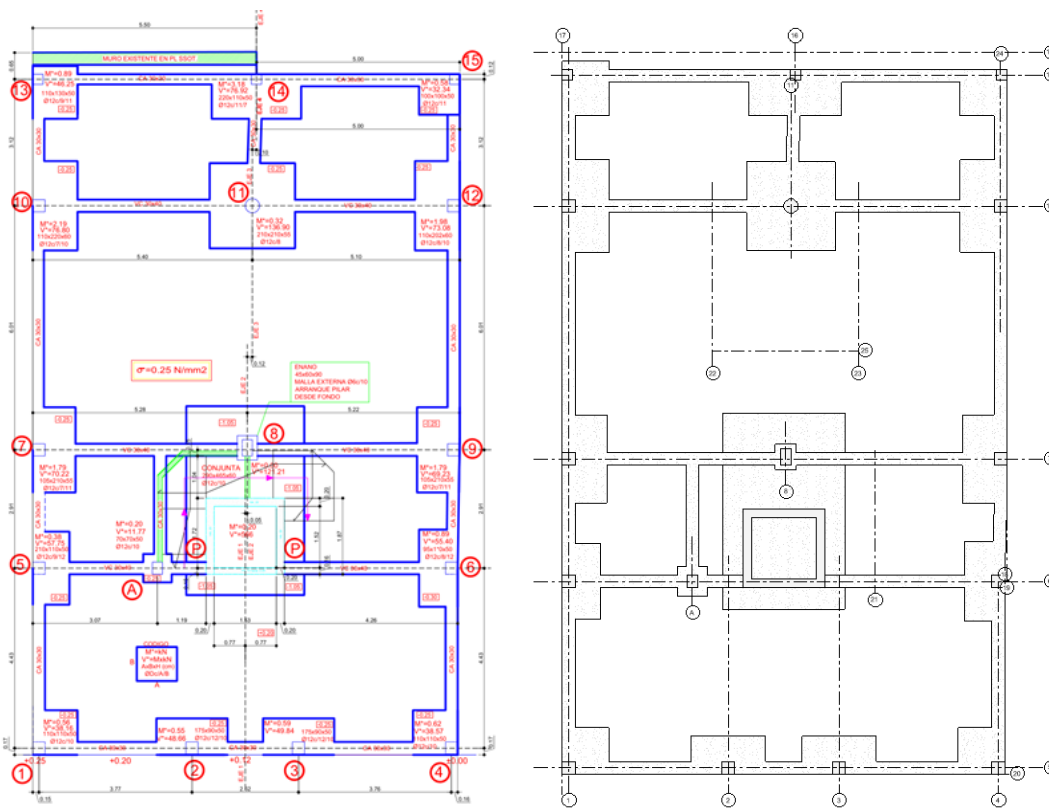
Planta de cimentación y ejes del proyecto. Fuente: Proyecto original y elaboración propia.
